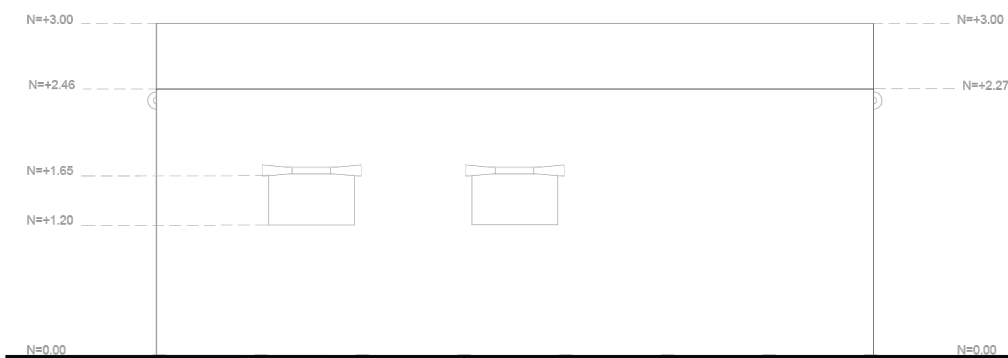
Elevación frontal del habitáculo Modular Emergency Plant. Fuente y elaboración: Autores.
